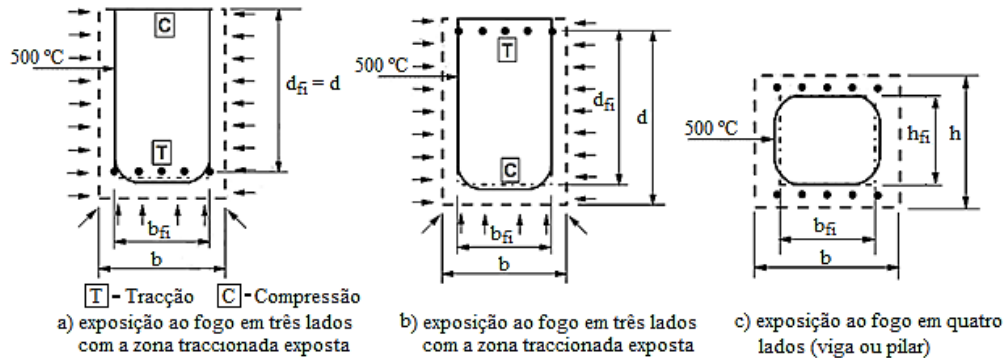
Secção reduzida para pilar ou viga de betão armado (NP EN 1992-1-2, 2010).
